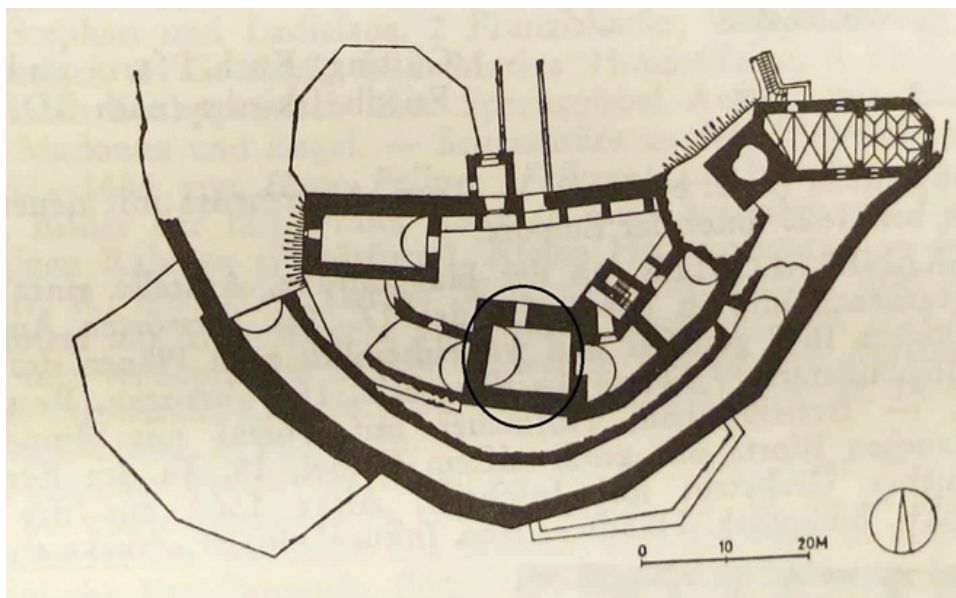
Burg Güssing. Grundriss der Hochburg mit eingetragenen Turm.
